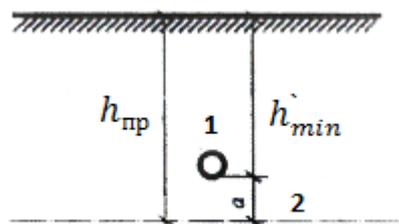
Схема глубины заложения трубопровода: 1 – трубопровод; 2 – граница мерзлого грунта
